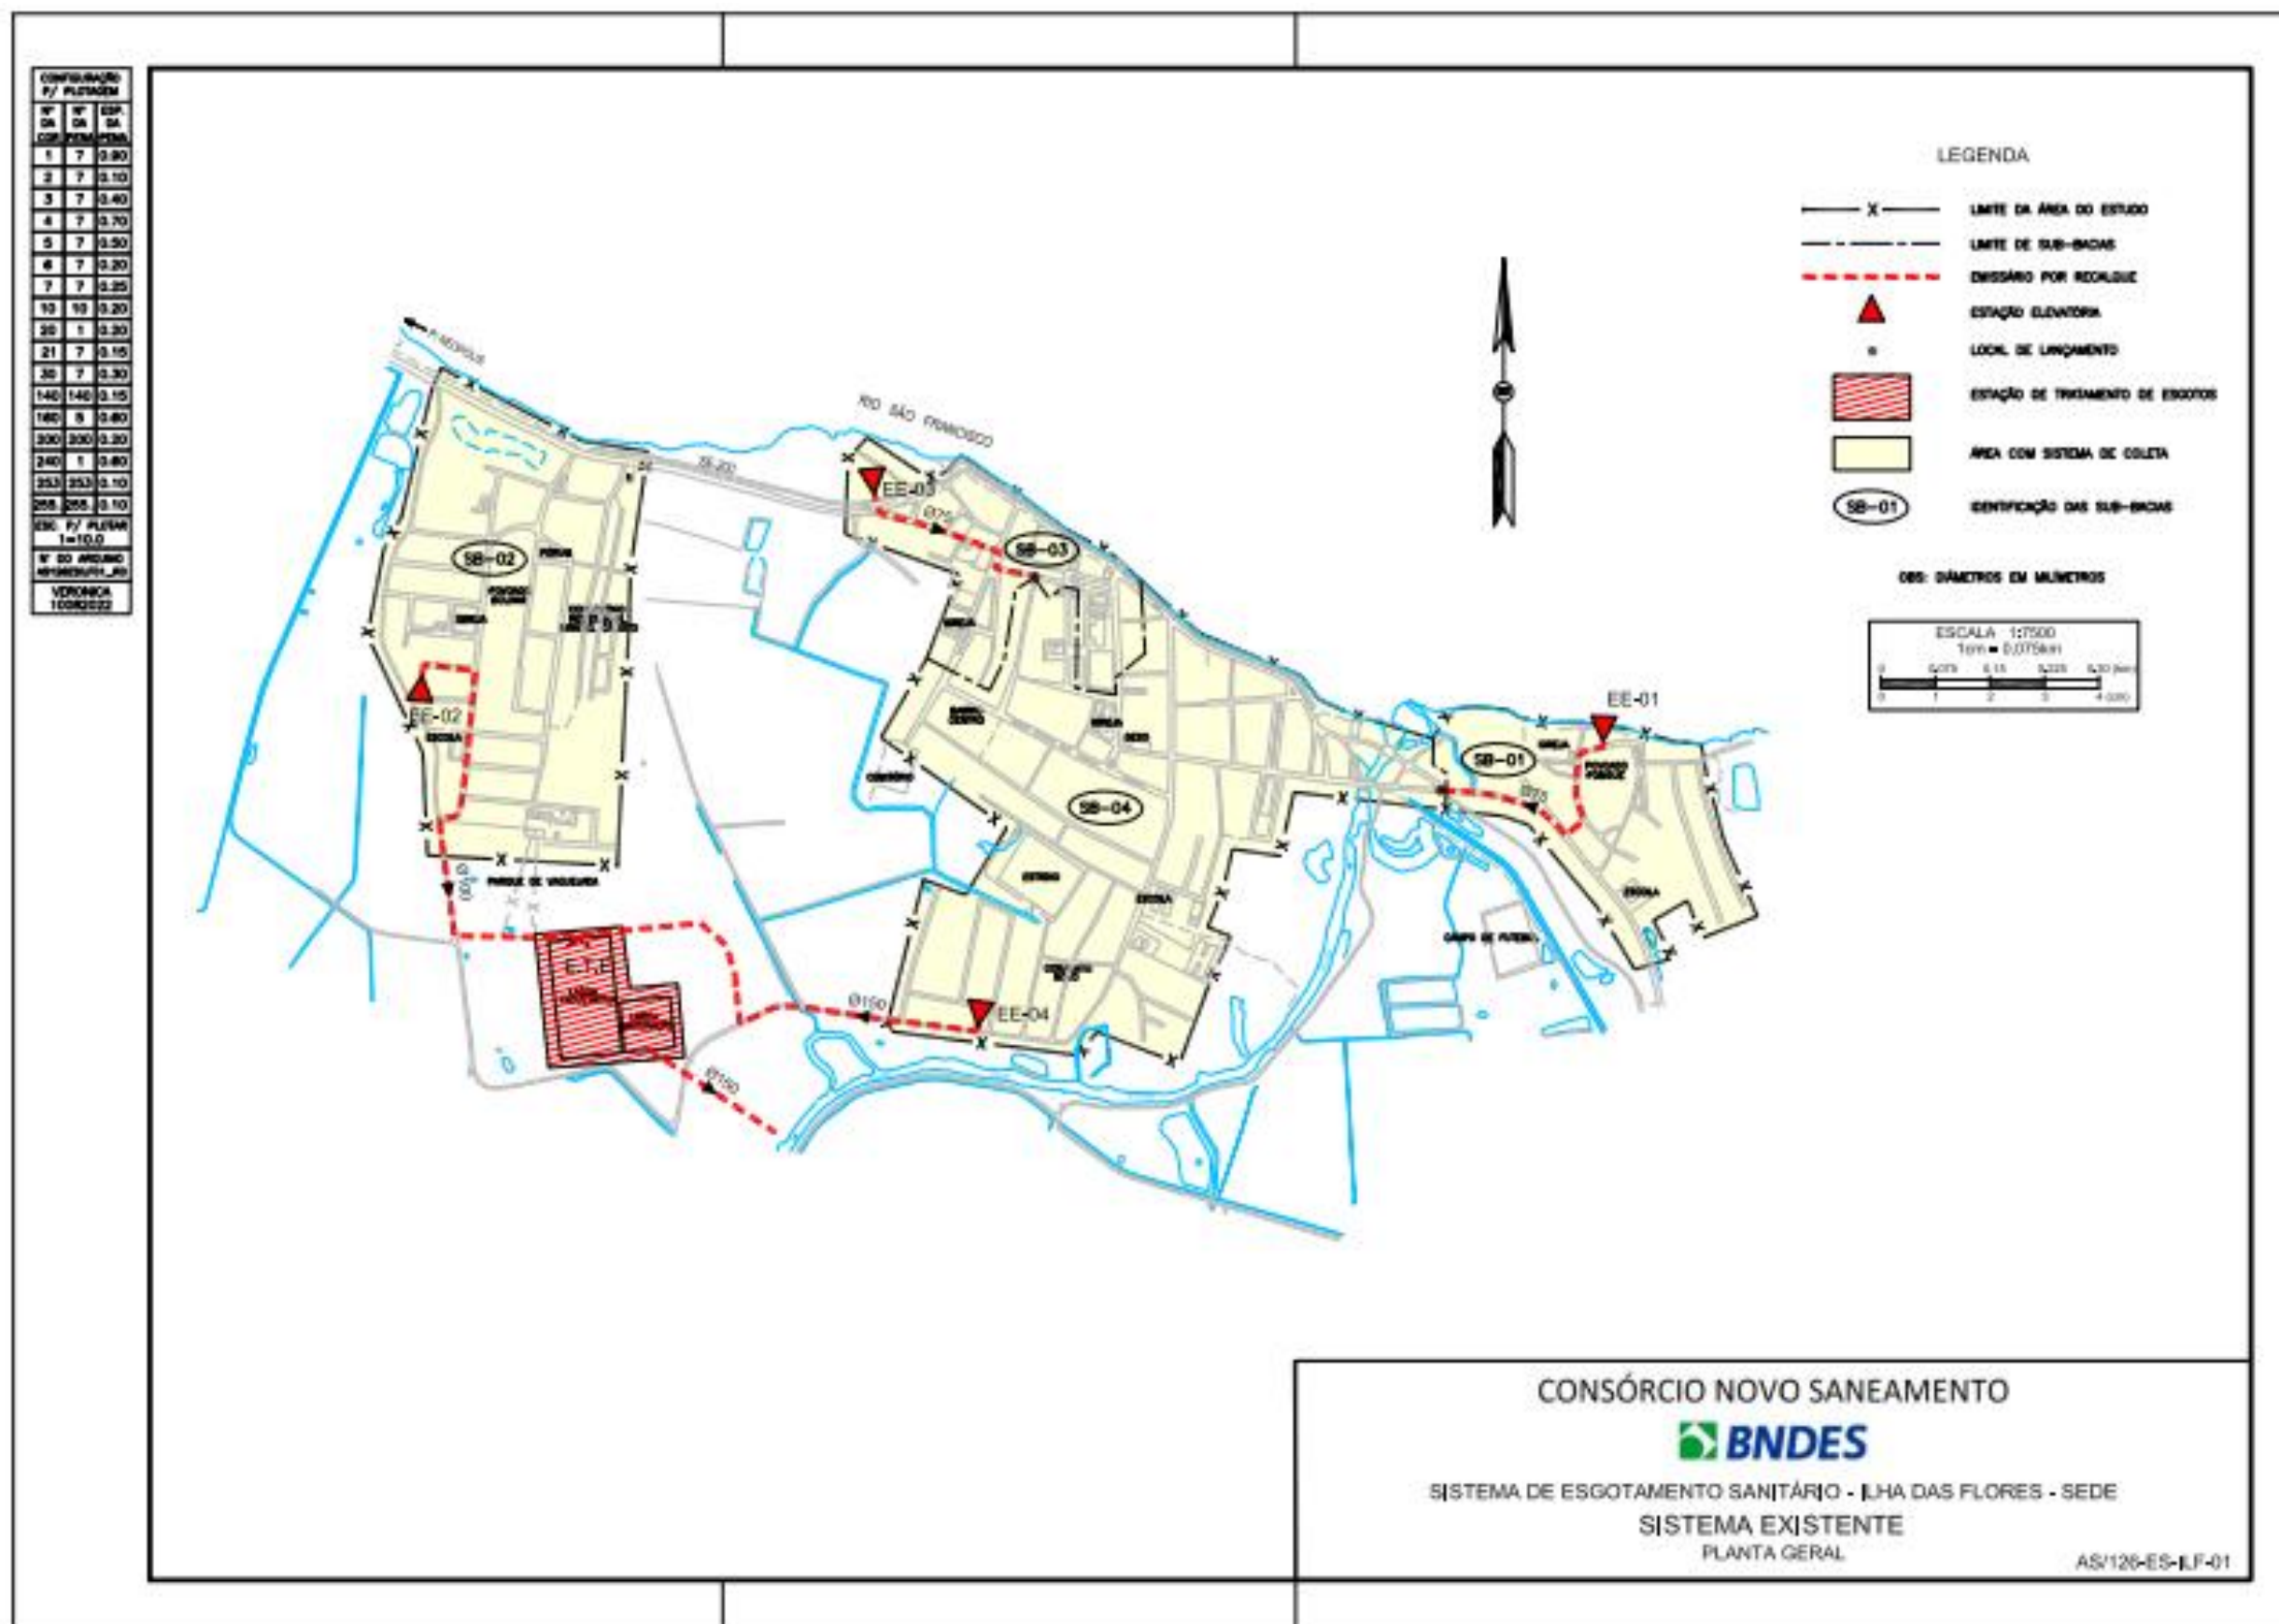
Planta do Sistema de Esgotamento Sanitário – ILHA DAS FLORES
